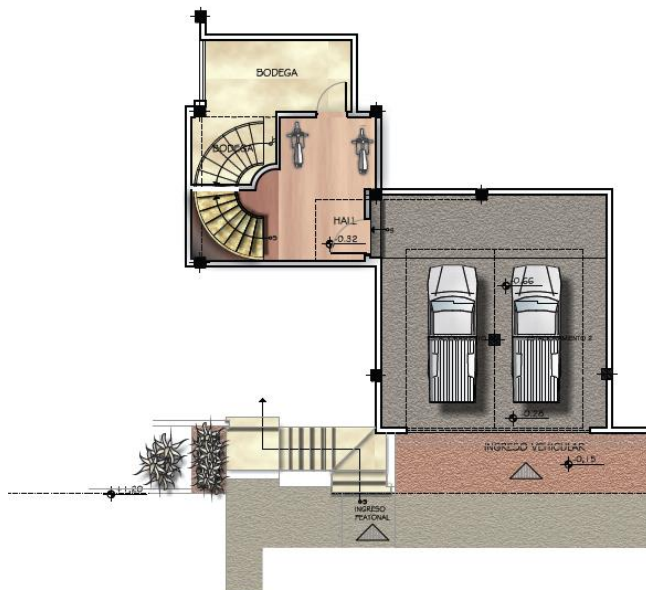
Planos arquitectónicos residencia 1
